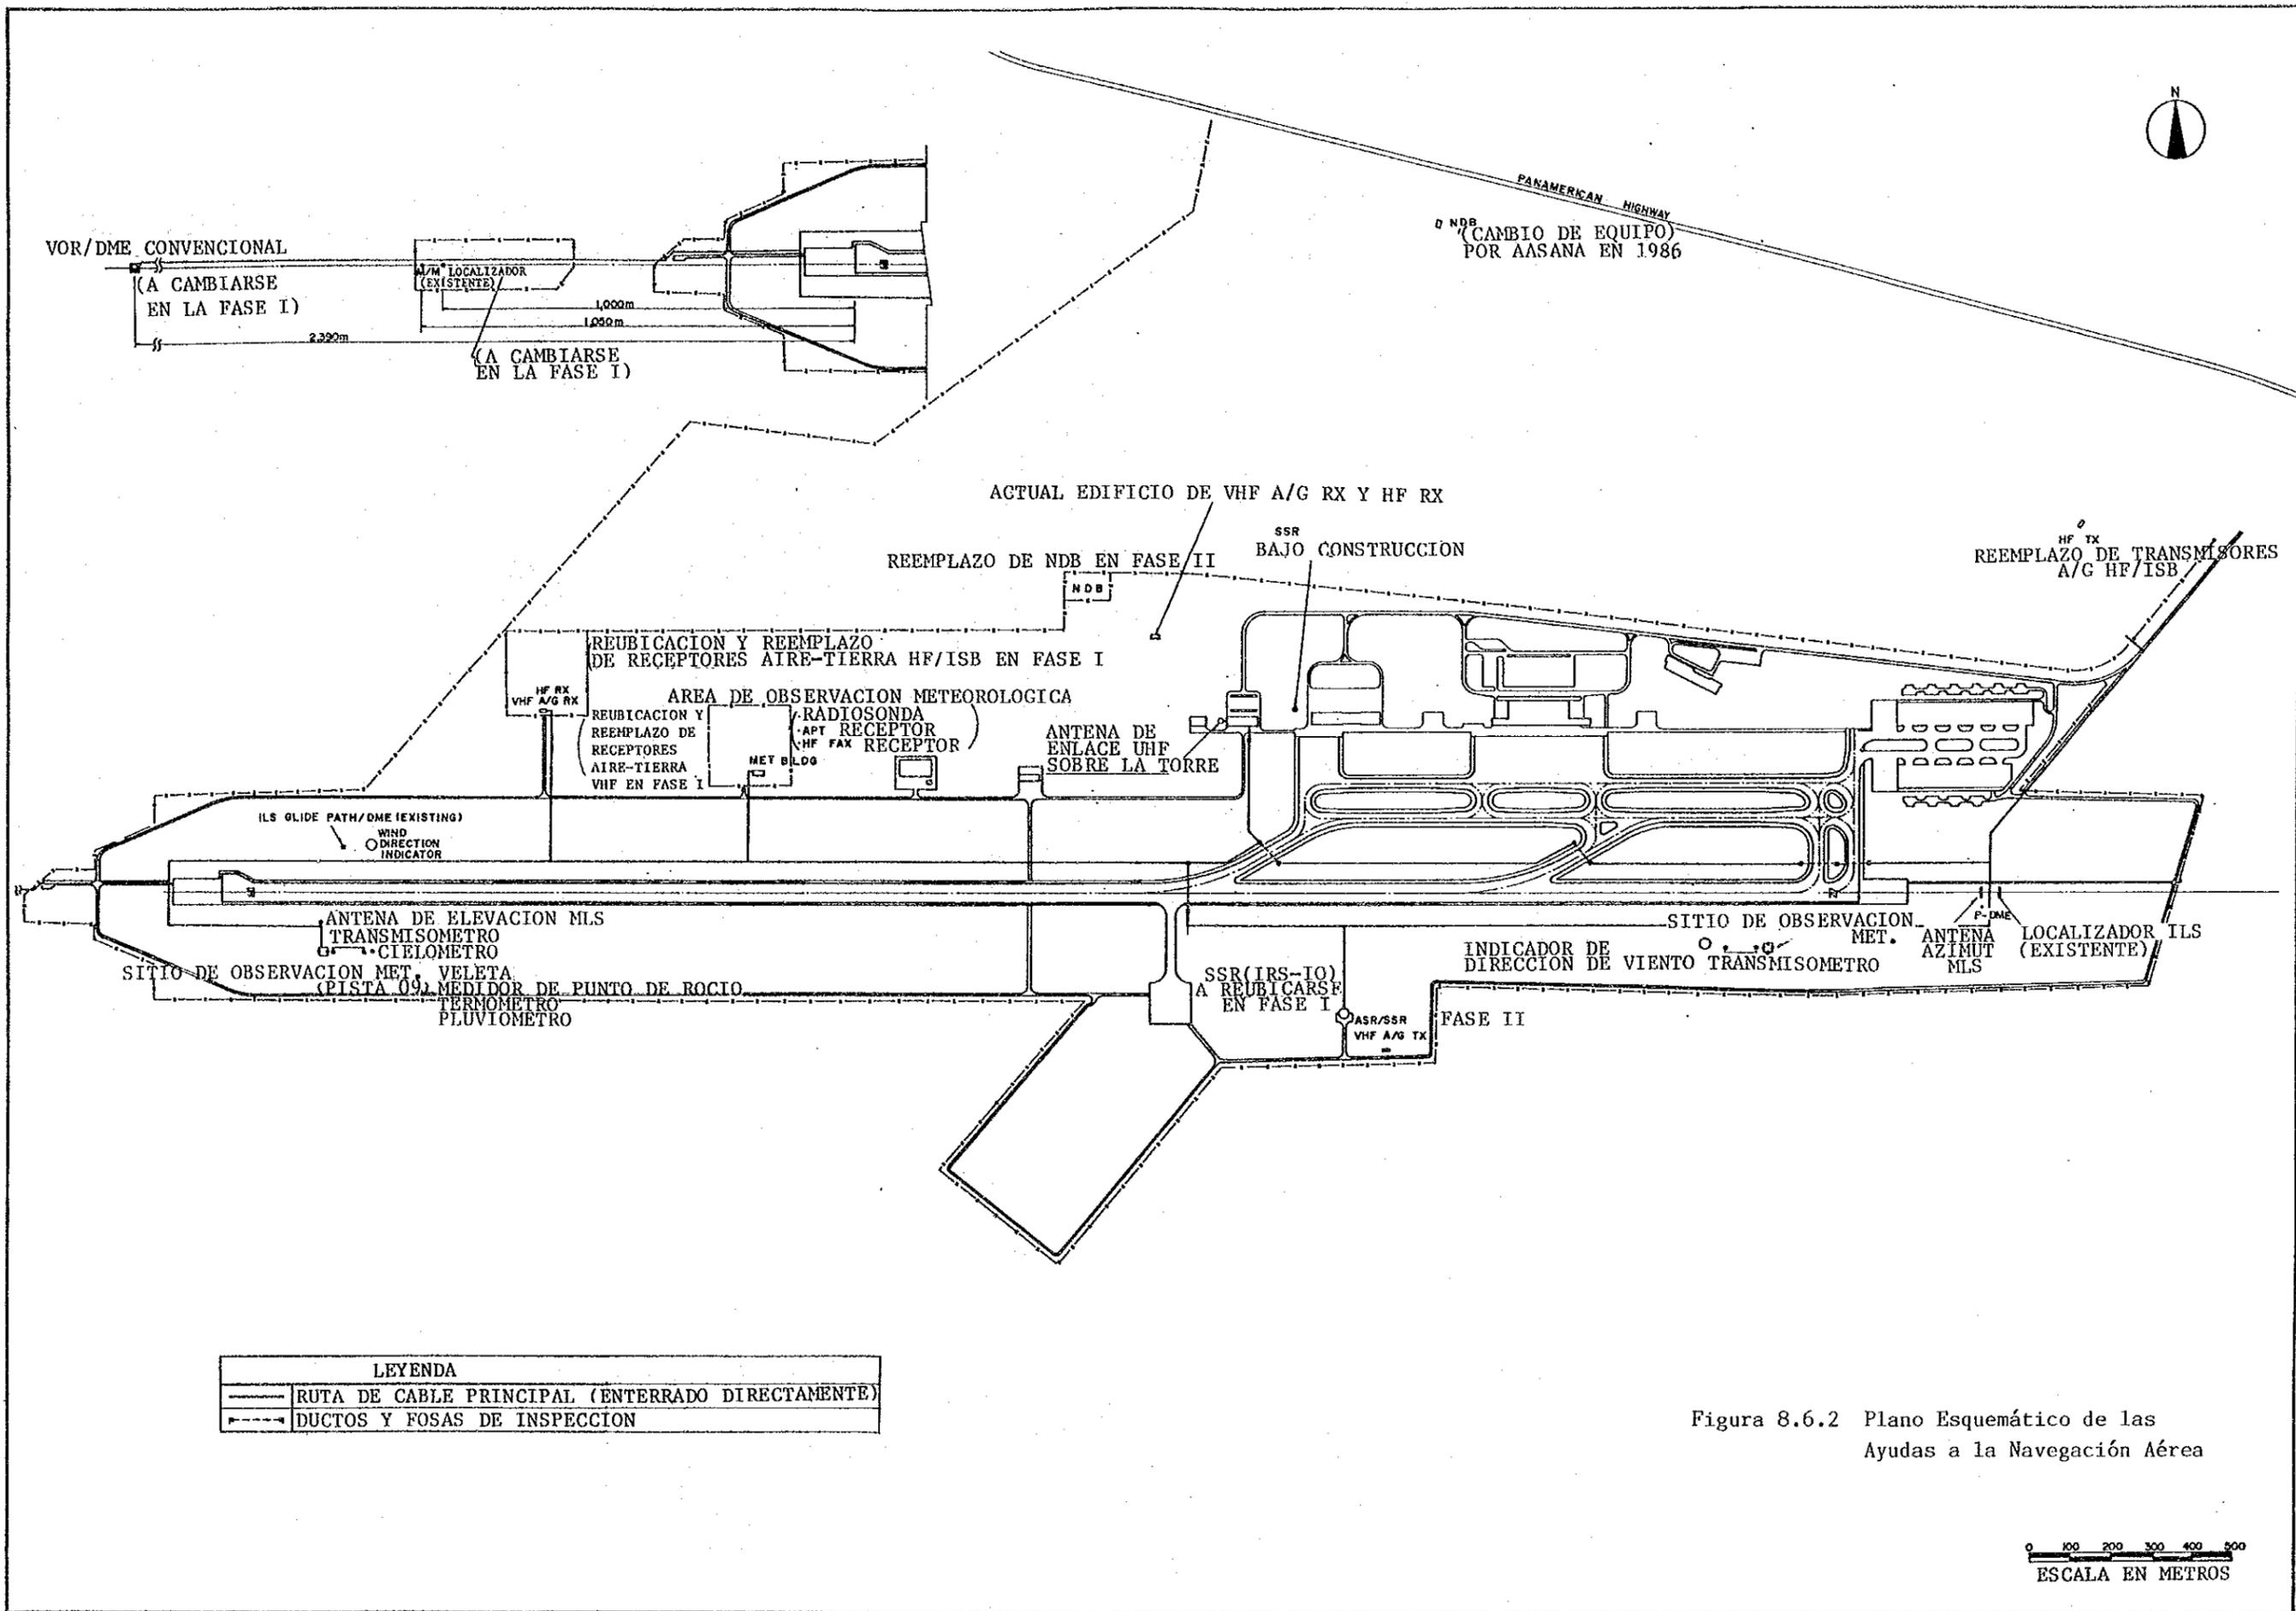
Plano Esquemático de las Ayudas a la Navegación Aérea
